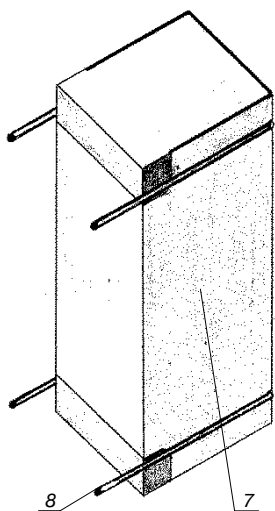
Оболочка трубобетонного элемента квадратного поперечного сечения с вырезами, заполненная бетоном; 8 – трубобетонный элемент, соединенный с анкерными арматурными стержнями (стержни условно обрезаны)
